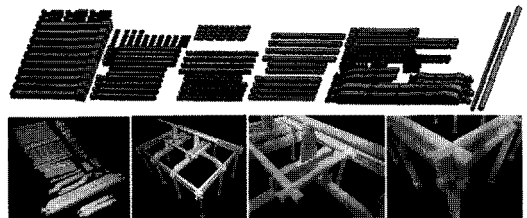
단위부재들이 건구된 집합부(Assembly)사전확인용 위한 검증모형(check model) [예천편세 범당 예시].
